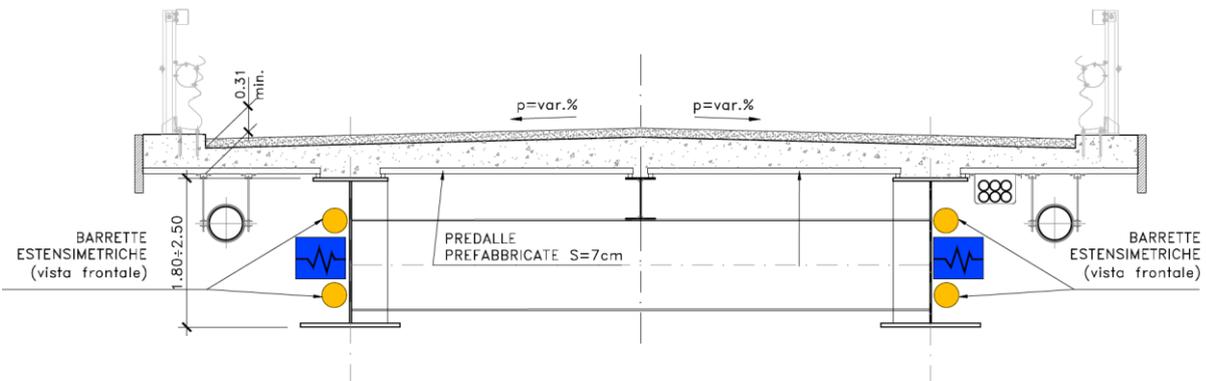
Sezione tipo impalcato posizionamento strumentazione
